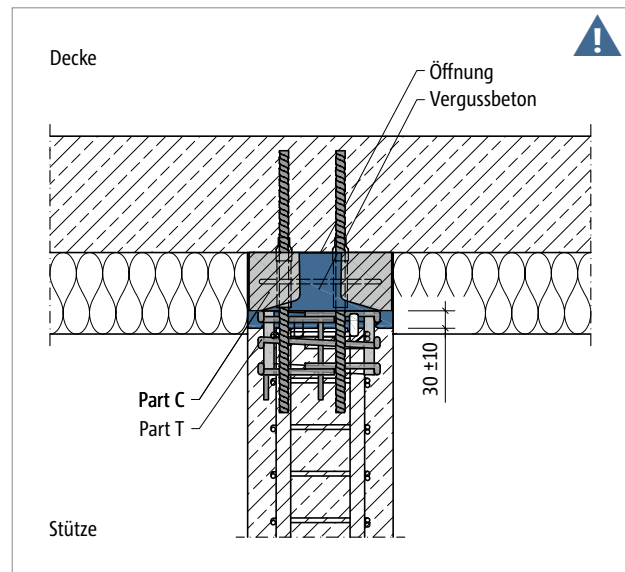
Schöck Sconnex® Typ P: Einbausschnitt; Anschluss Stütze – Decke mit Formschluss zum Stützenbeton durch PAGEL®-Verguss V1/50
